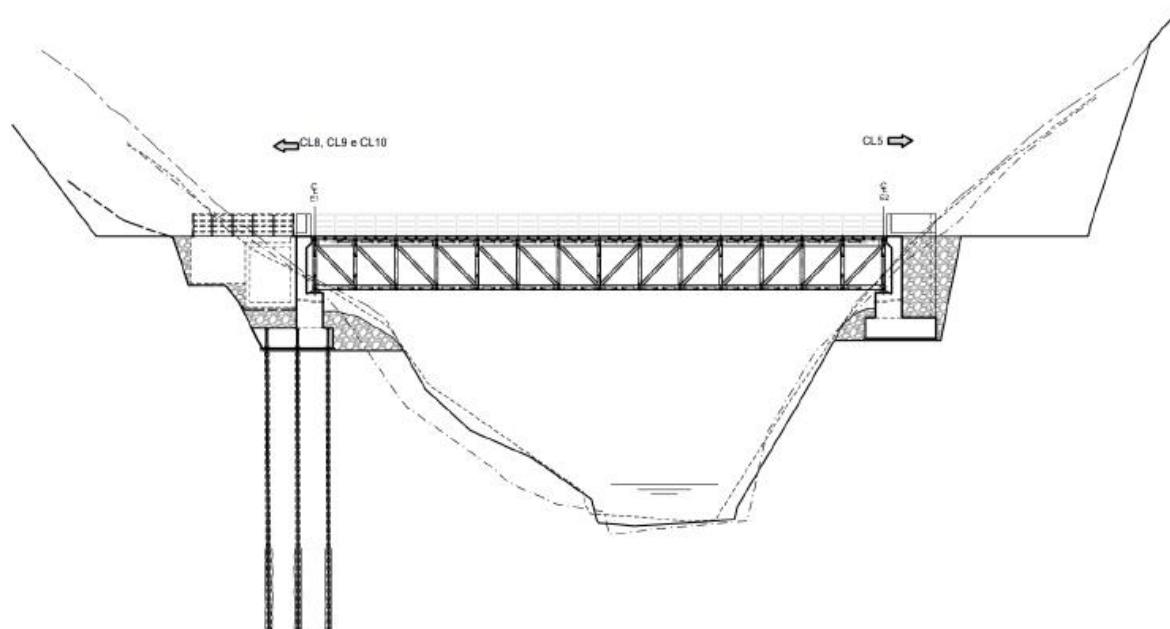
Fase IV: Execução da Ponte metálica e instalação de equipamentos
